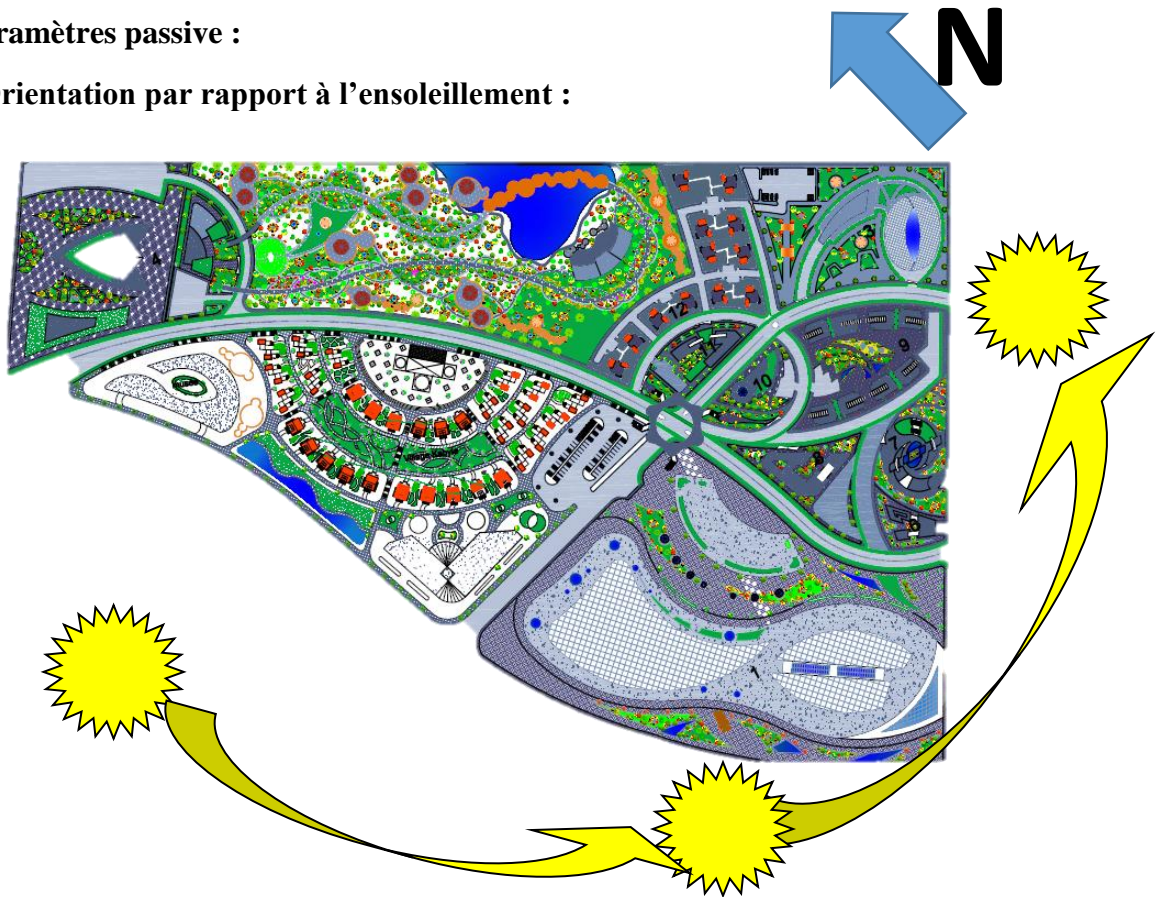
Schéma d'ensoleillement du plan d'aménagement ⁽⁶⁾
